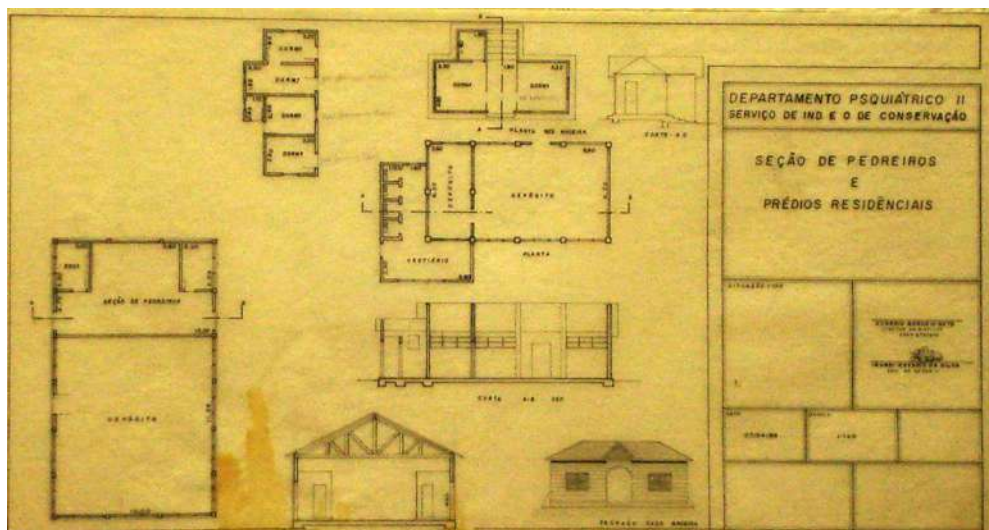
Planta, corte e fachadas das construções que compõem os itens acima (acervo do SIOC)
